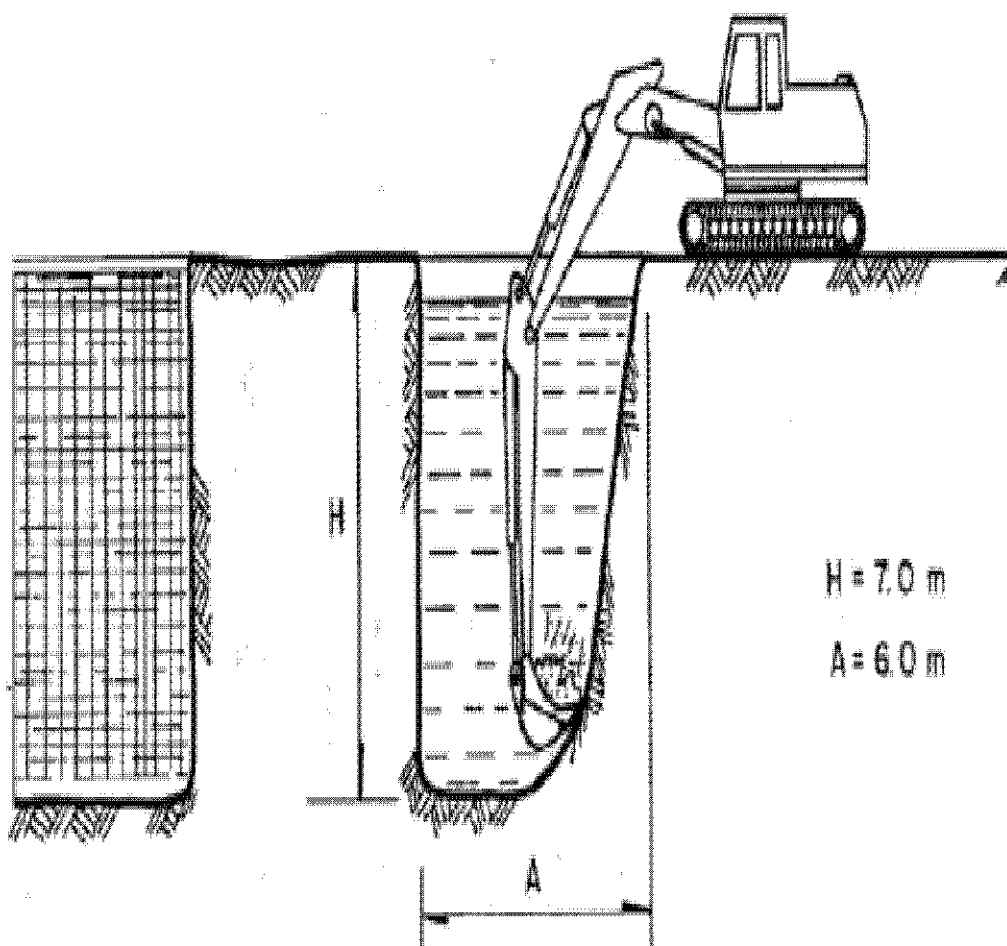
a1 Excavación de la zanja con retroexcavadora
